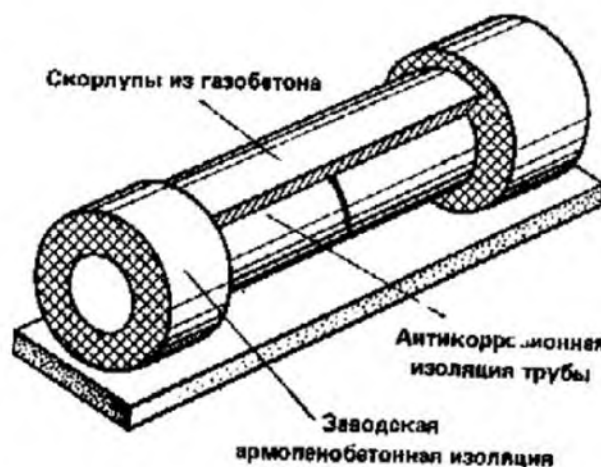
Теплоизоляция газобетоном или армированным бетоном
